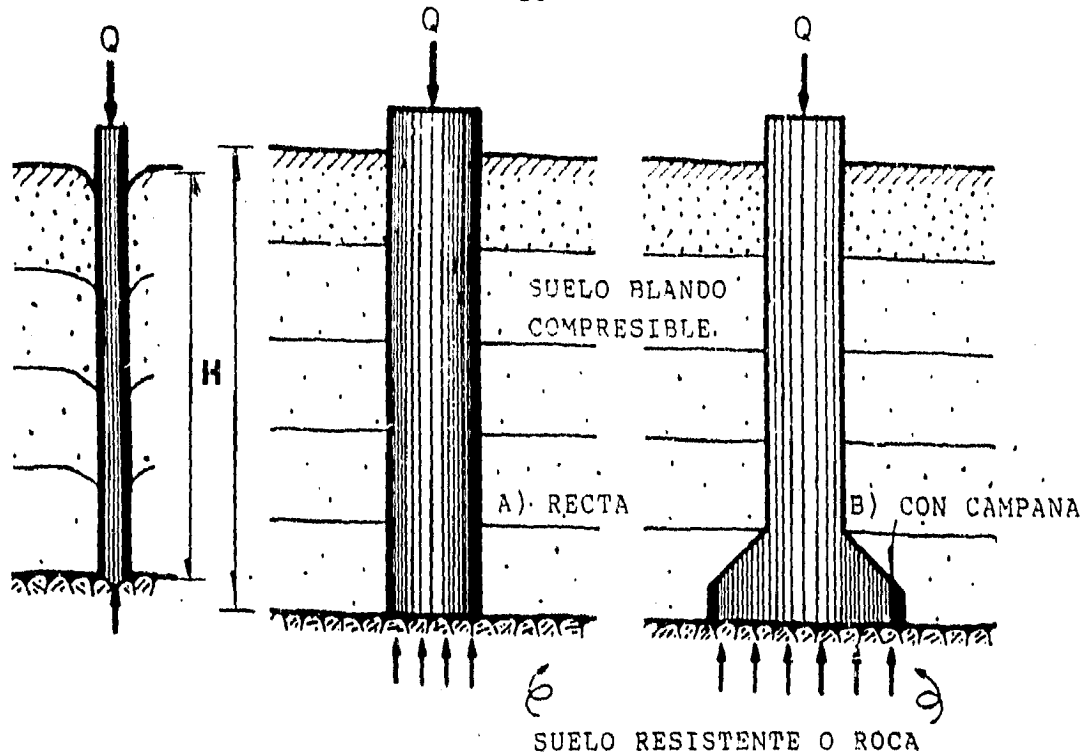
PILOTES Y PILAS APOYADOS EN PUNTA
